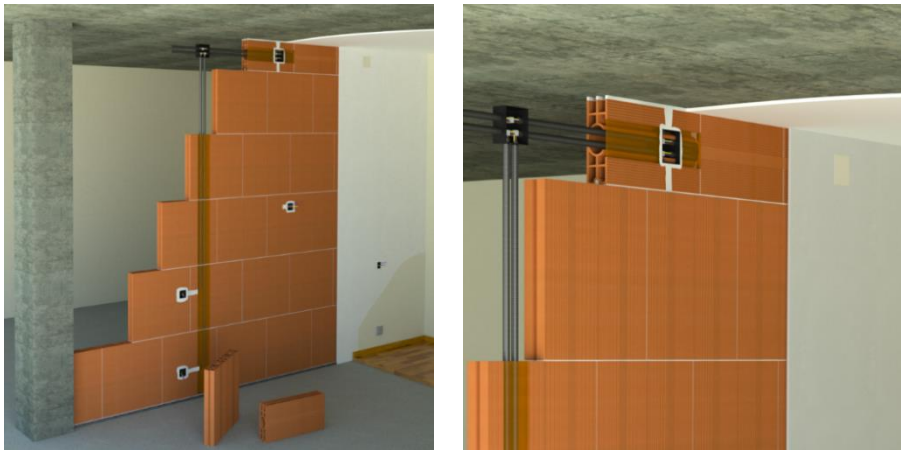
Detalles de la colocación de las instalaciones en una fábrica de MURALIT Sin Rozas en una obra SIN FALSO TECHO
